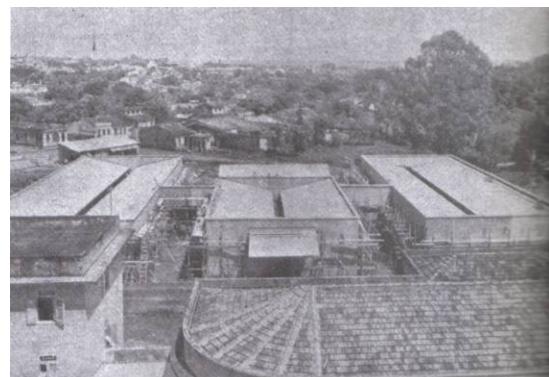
Vista dos pavilhões do Parque Sanatorial Santa Terezinha, na Bahia, em 1949.
